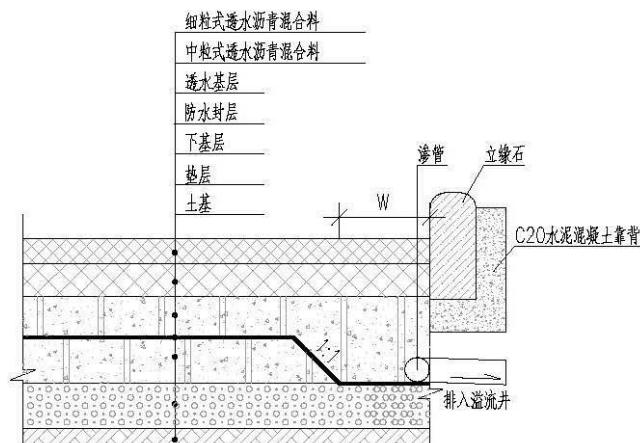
半透式沥青路面边缘排水设施示意图
